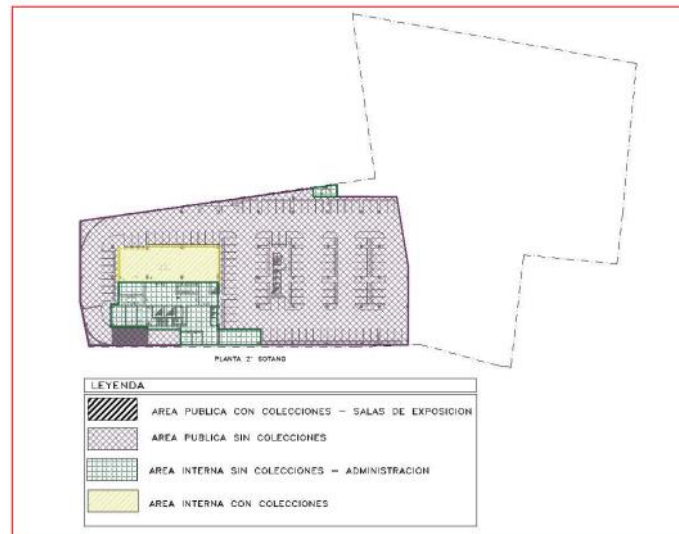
Planta 2. Sótano. Fuente: Equipo consultor.
